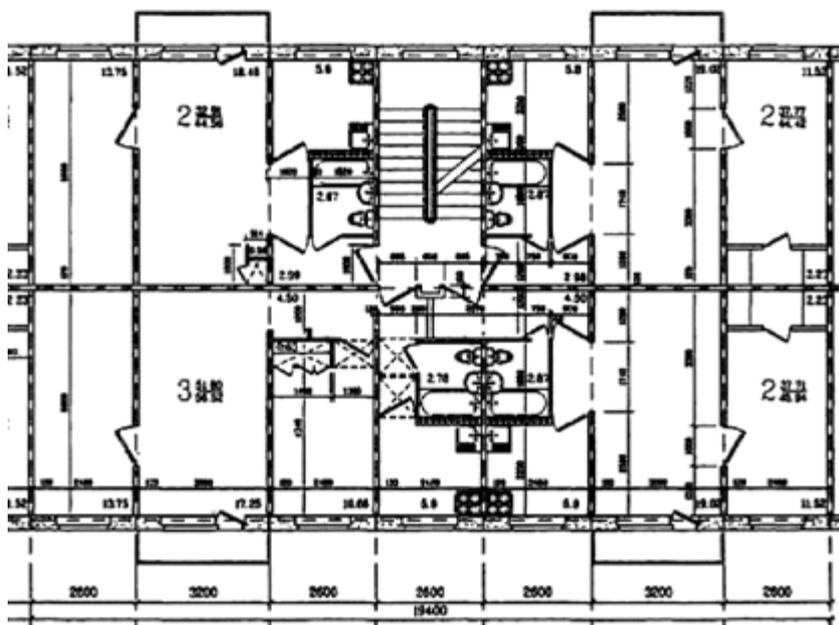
Планировочные решения квартир и помещений при узком шаге несущих конструкций
